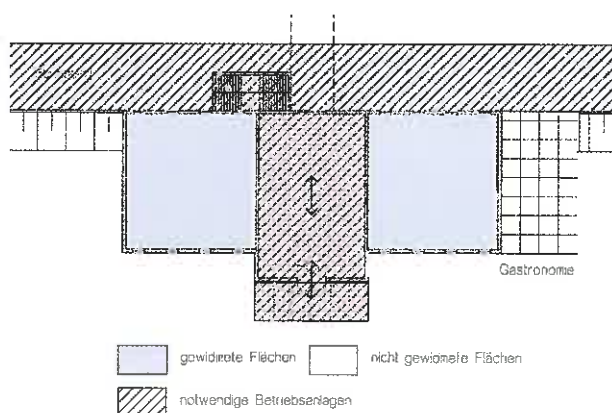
Notwendiger Bahnsteigzugang durch Gebäude ohne Gebäudetrennung
